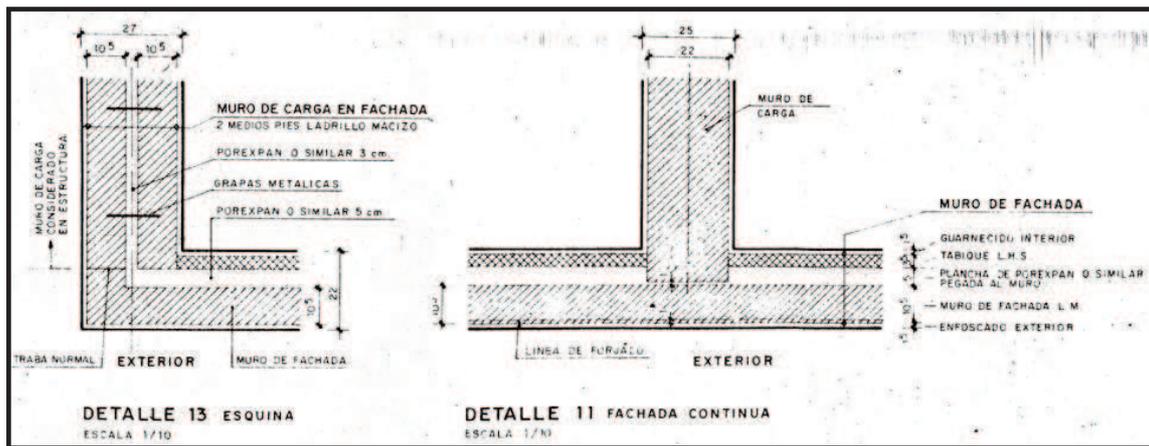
Detalles de encuentro de muro de carga en fachada y muro de carga interior con el cerramiento exterior. Extracción del proyecto original, archivo de Mairena del Aljarafe.
